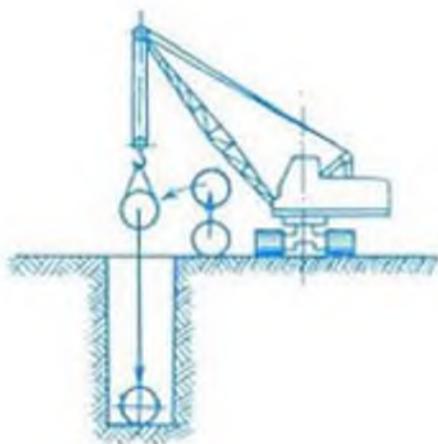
Строительно-оросительных систем. Подача звеньев труб в траншею передвижными подъёмными кранами на тросовом или пневматическом ходу.
